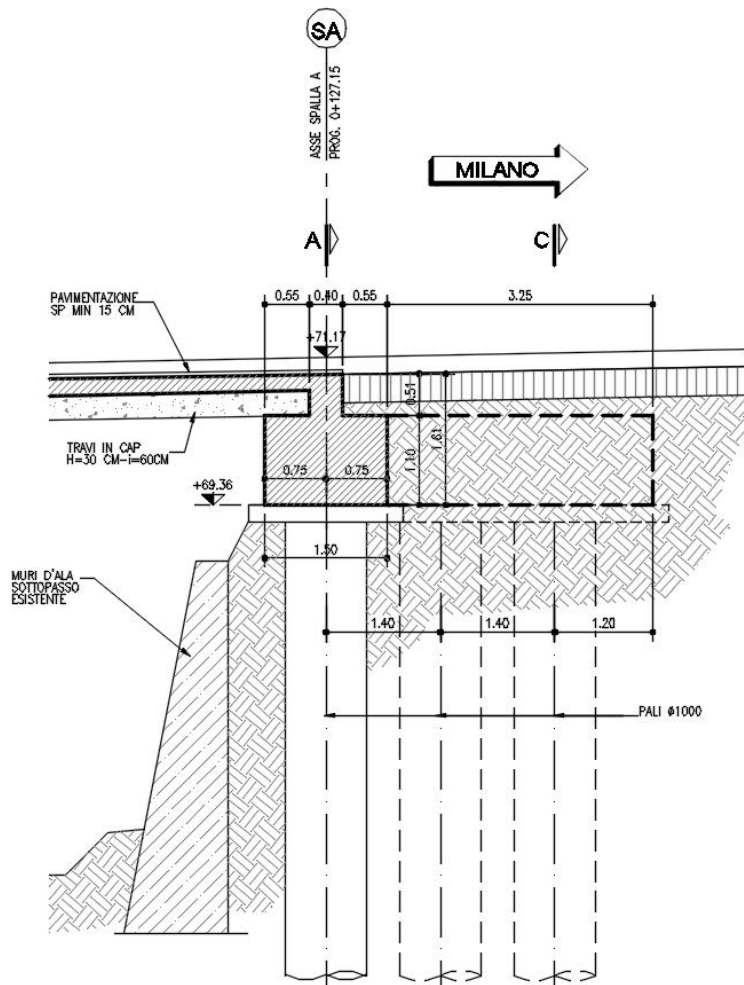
Spalla lato Milano - Sezione longitudinale
